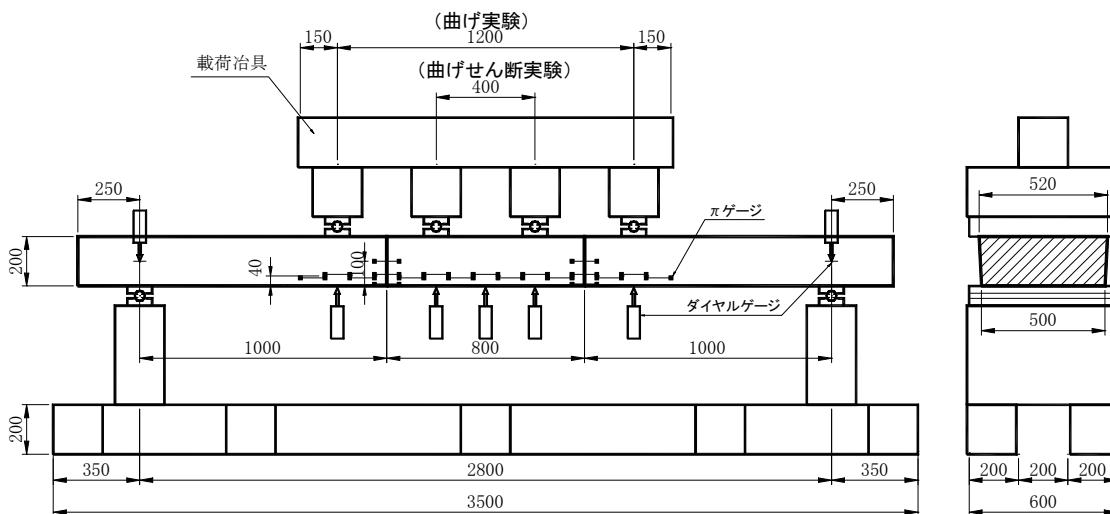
スパン、荷重位置および変位、ひび割れ計測位置
